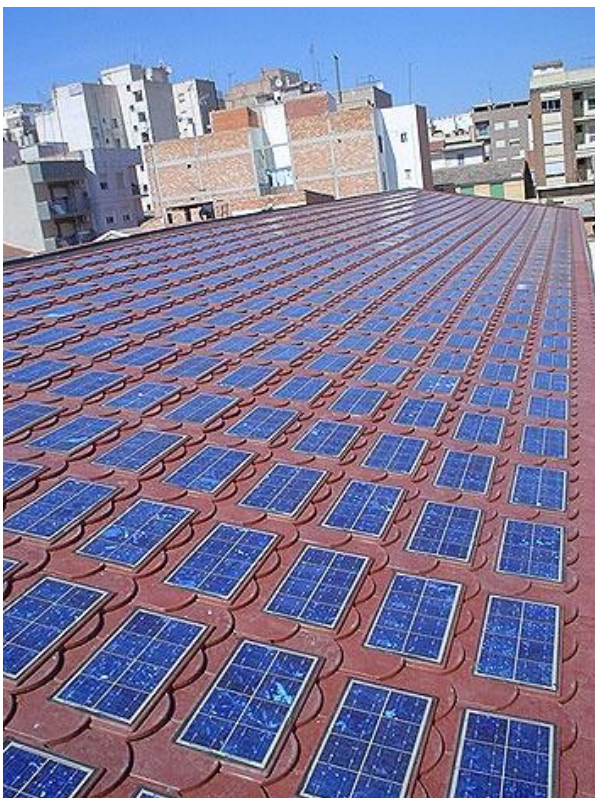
Superposición en cubierta inclinada; Miraflores de la sierra, Madrid.
